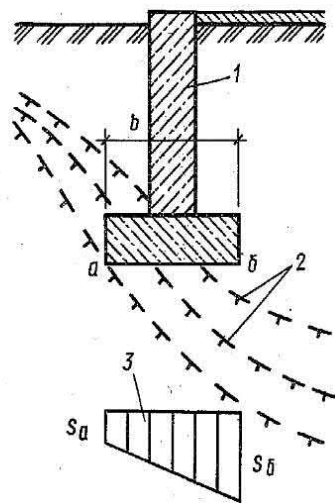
Изменение во времени зоны оттаивания под фундаментом наружной стены:
